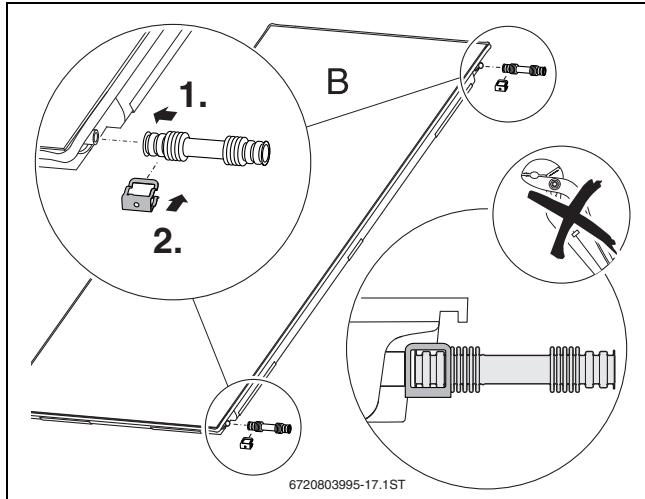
Montaggio del set di collegamento al secondo collettore e su tutti gli altri
